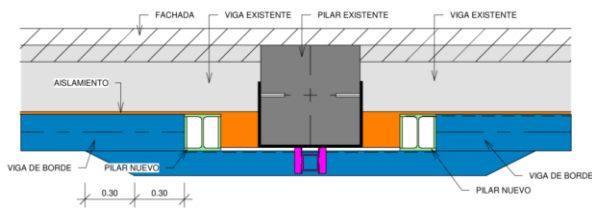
Estructura metálica adicional en fachadas del ala Oeste
